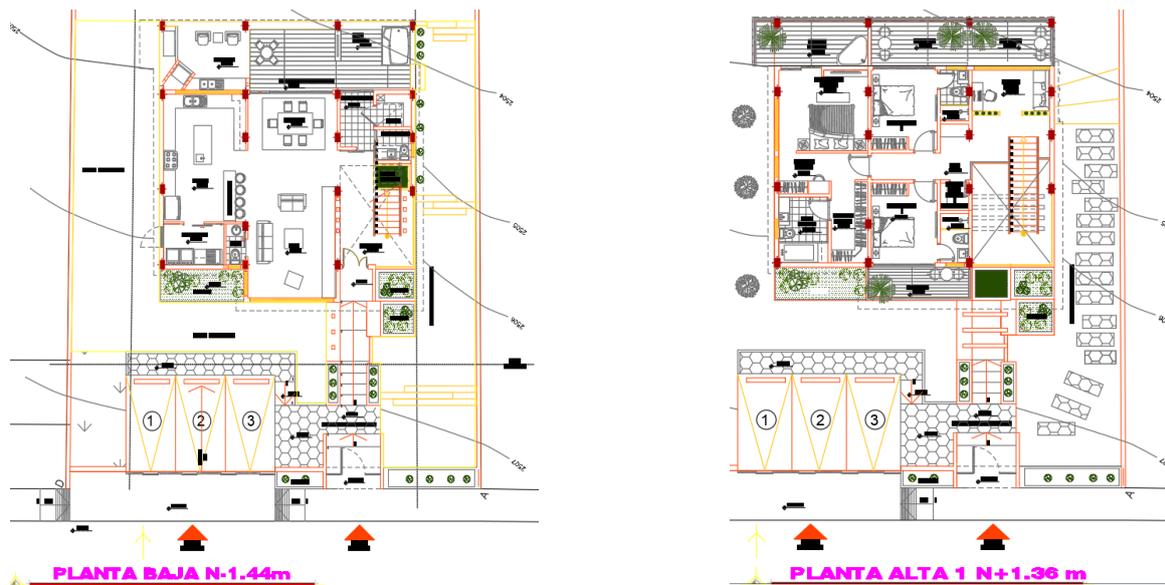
8 Configuración de la planta baja y planta alta de la vivienda [Arq. Elizabeth Revelo]
